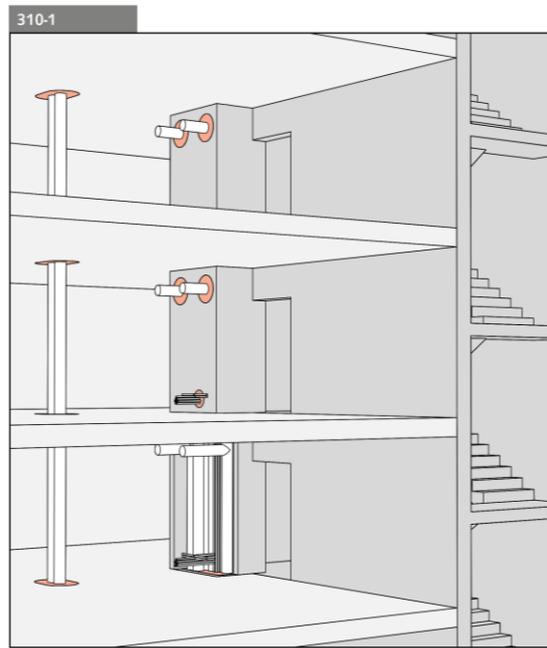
Durchdringungen durch brandabschnittsbildende Bauteile aufgrund gebäudetechnischer Installationen (Abbildung 310-1 gemäss [2])
